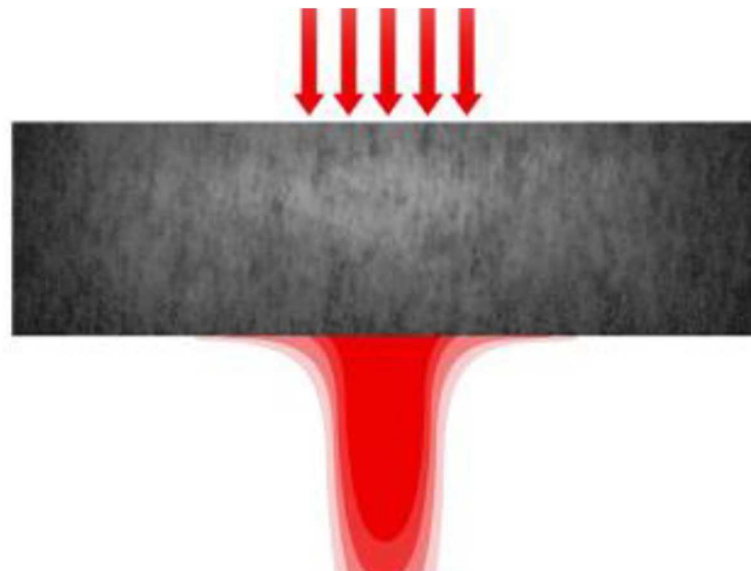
Estrutura dos pavimentos rígidos (corte longitudinal)
